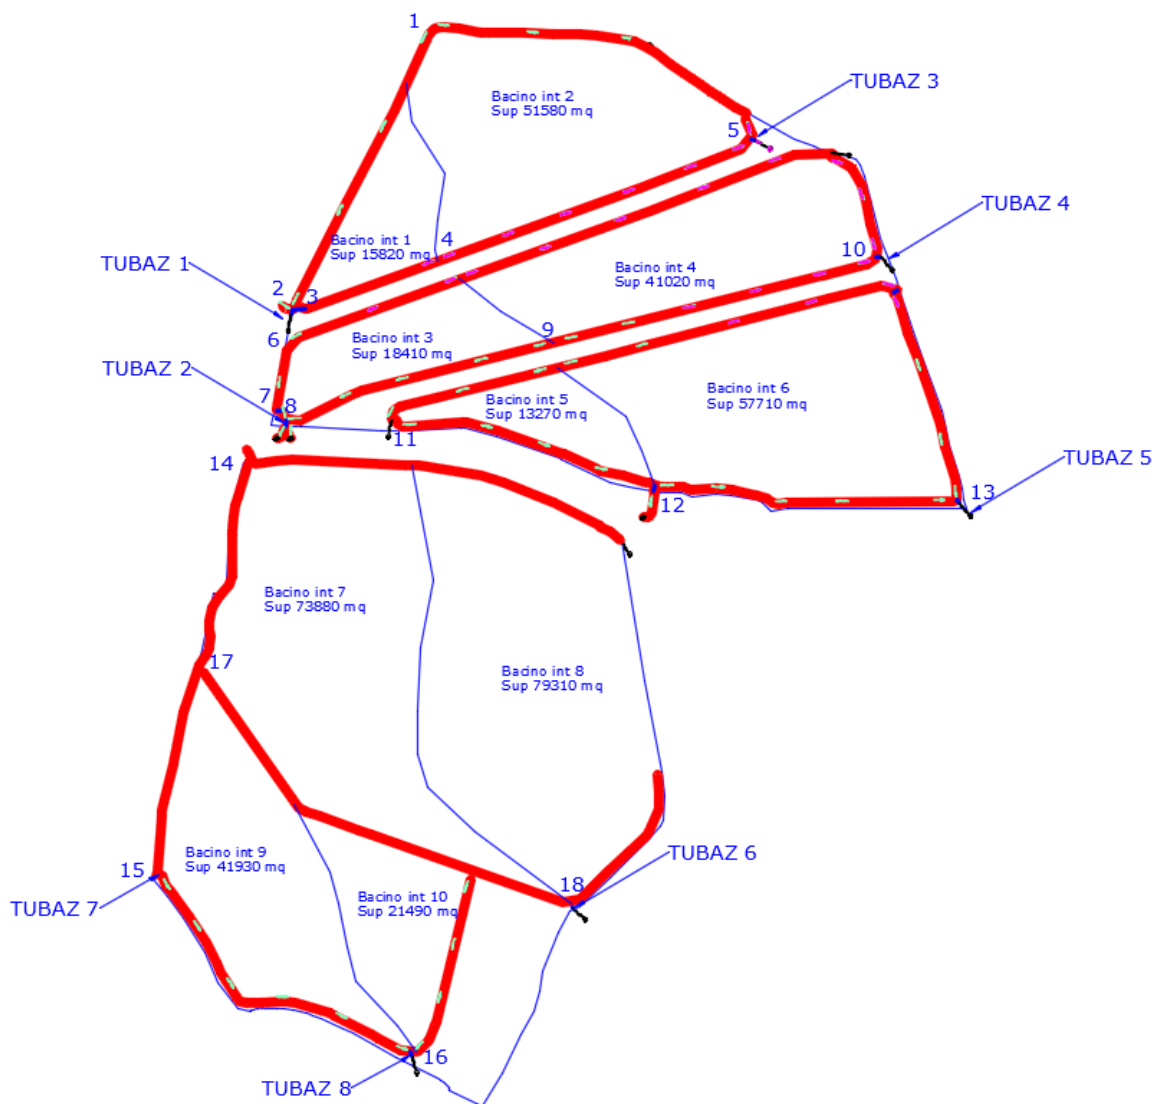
Planimetrie con individuazione dei bacini interni all'impianto
